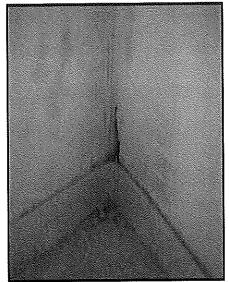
Flux d'air au niveau des liaisons périphériques (parois, plancher) dans la chambre
